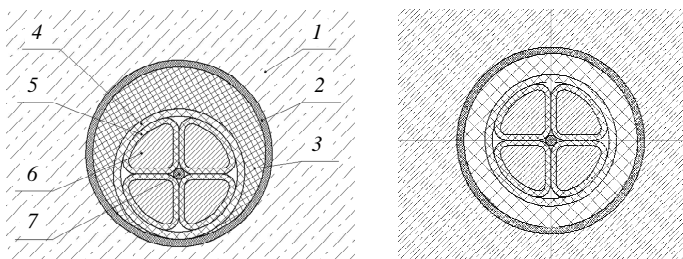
Проход кабеля АВВГ 4×120 через стены или перекрытия:
